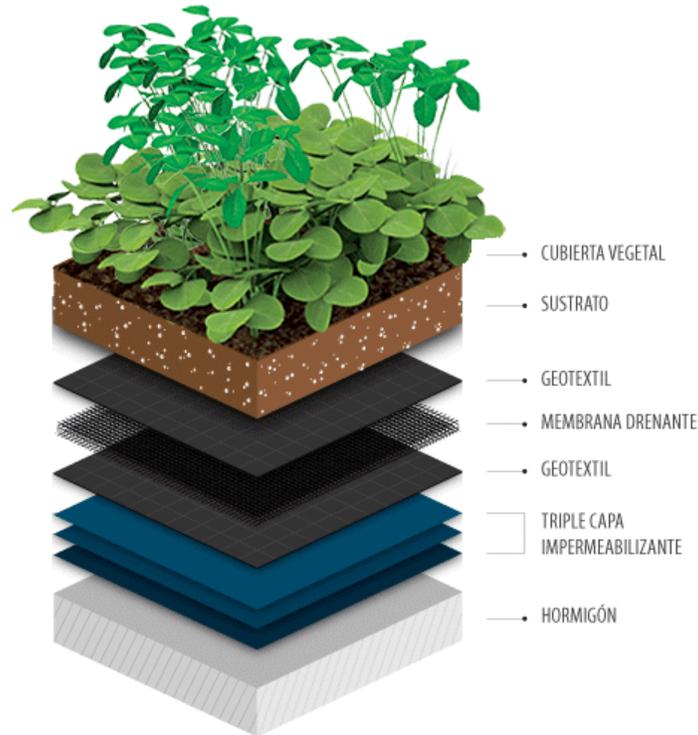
Sección de una cubierta o techo verde. Fuente. <https://www.newgreen.com.ar/terrazas-verdes-newgreen/>
